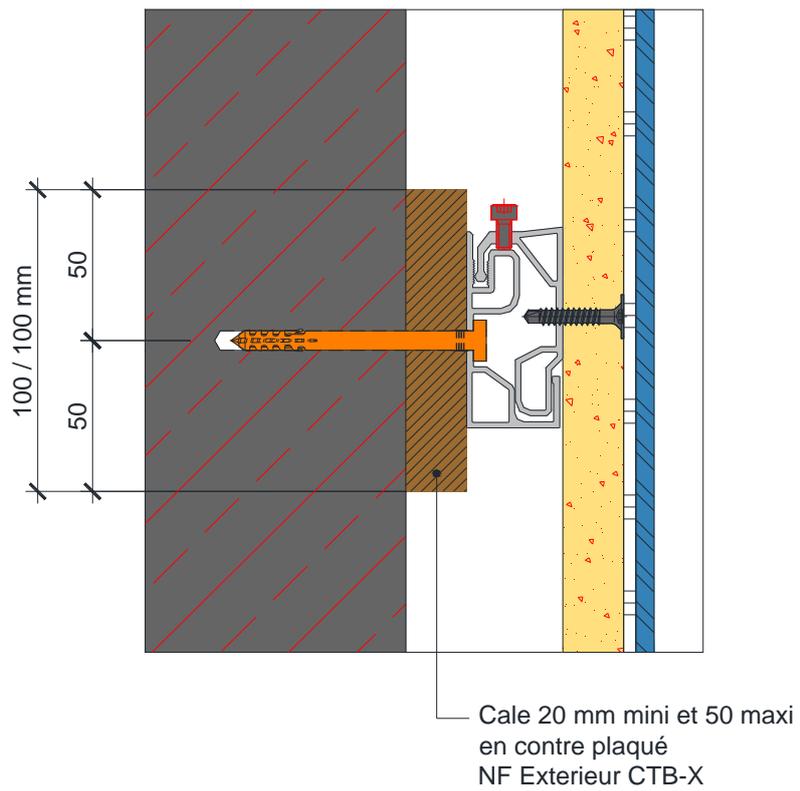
Détail pose directe sur le support sur béton et maçonnerie avec cale 100 x 100 x 20 mm mini
